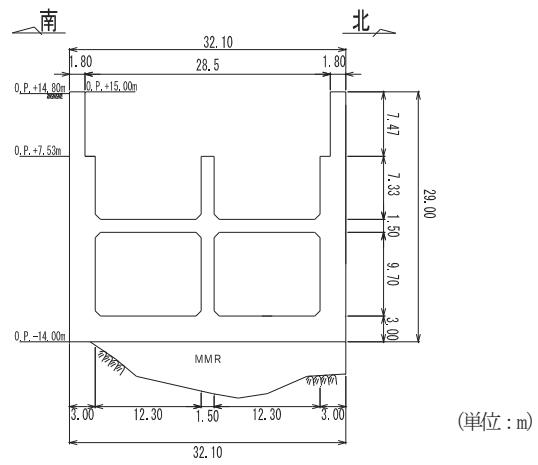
第3号機海水ポンプ室断面図 (B-B)
